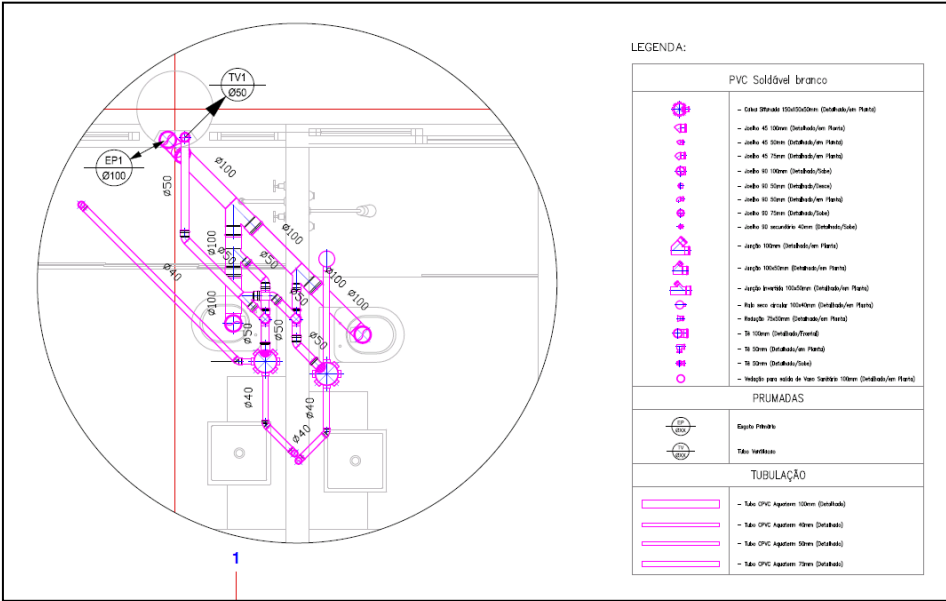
Tubulação de esgoto do 1º pavimento: detalhe 1 e legendas. Fonte: AUTOR (2017).
